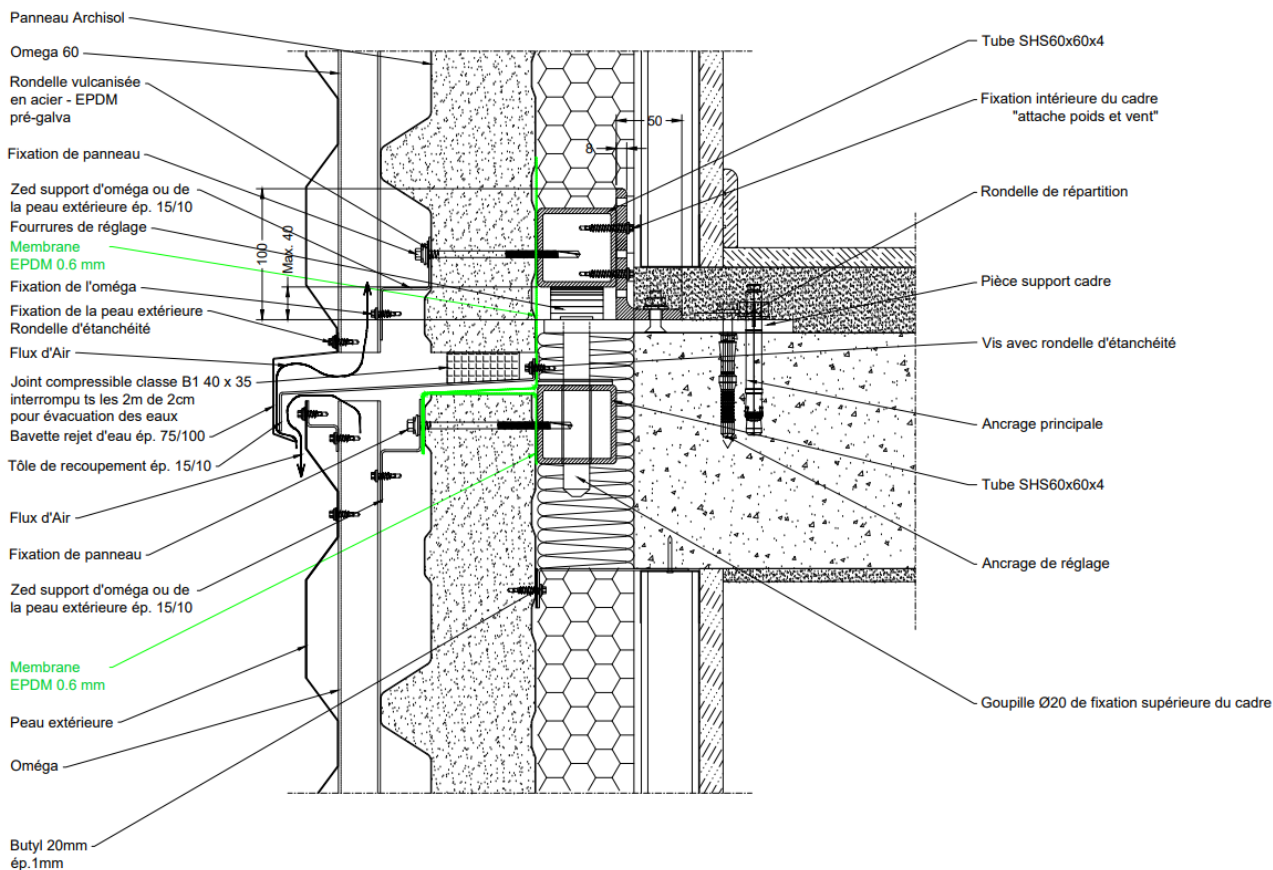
Coupe verticale sur la jonction horizontale entre modules D2B Archisol – Ancrage de rive (poids et vent) - Ossature en simple réseau
